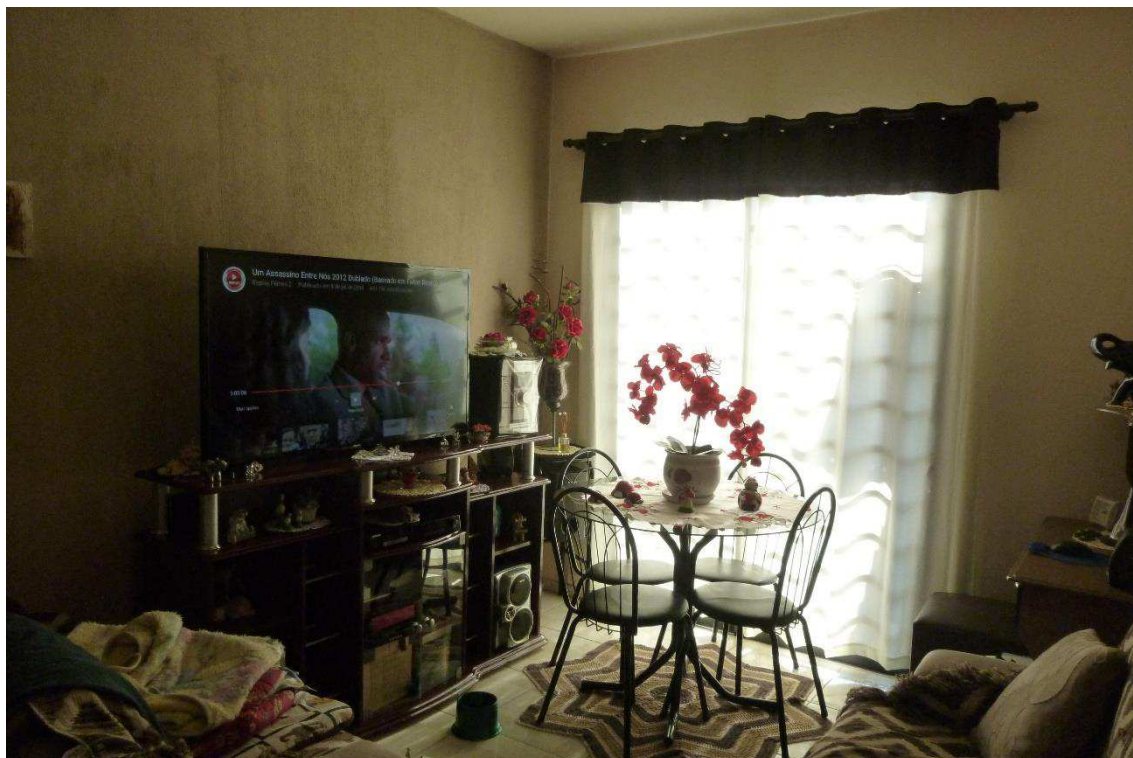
Vista da sala da casa dos fundos com piso cerâmico e laje de forro, pintura em razoável estado de conservação.
